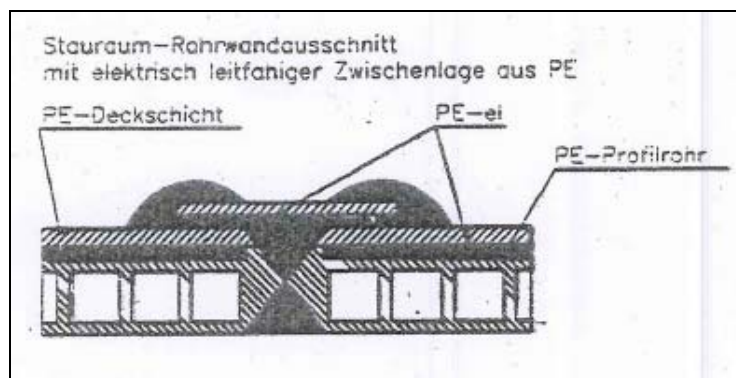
Detail Schweißnahtausbildung EL 3-Schichtsystem
